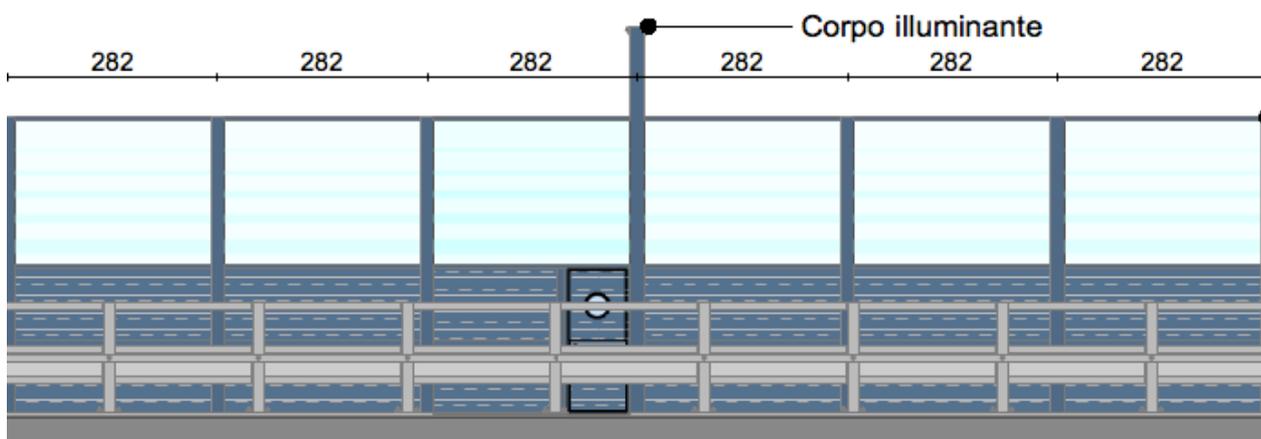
Barriera Interna – Prospetto tipo – lato strada.
